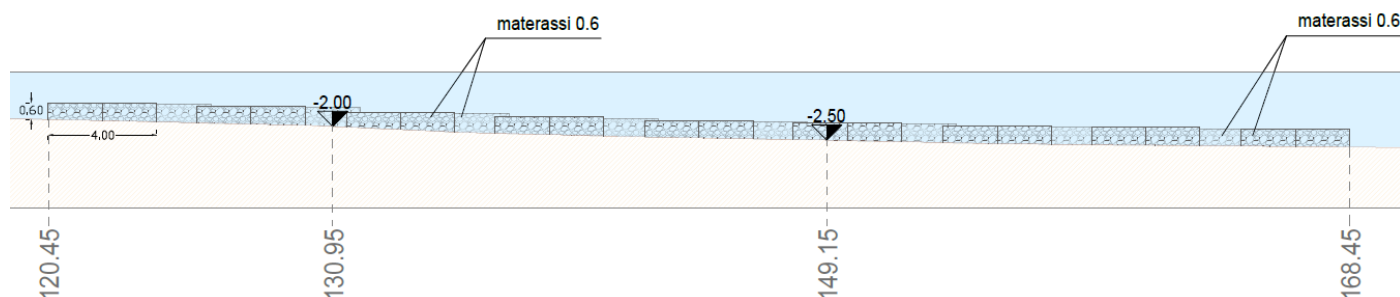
ALTERNATIVA 2 - Sezione di progetto costa-largo (per maggiore dettaglio si rimanda all'allegato Planimetria e sezioni del PFTE).
